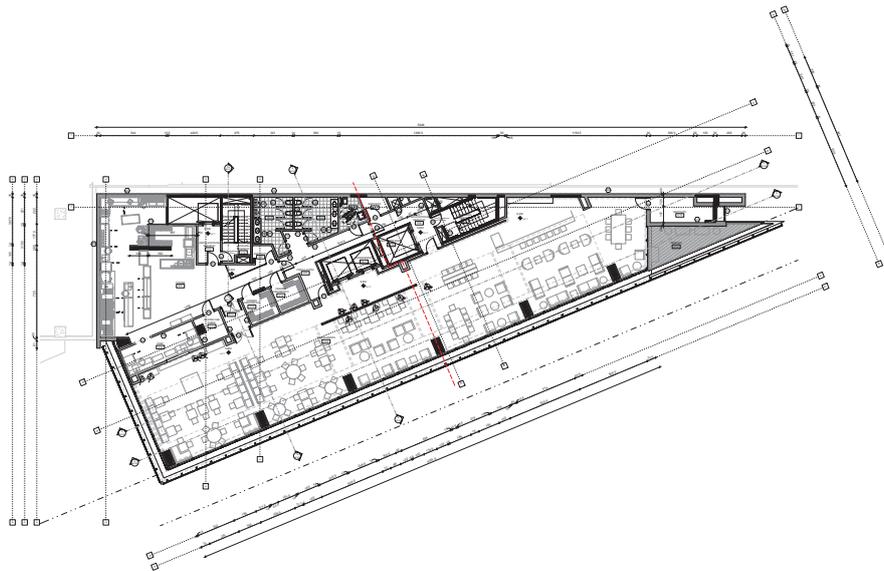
Planta Nivel 2. Fuente: archivo estudio GP.
